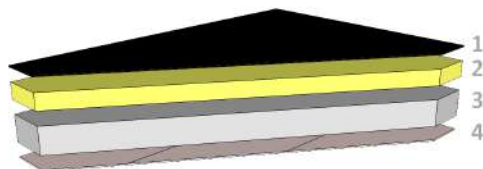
Composition de la toiture de la construction traditionnelle (Delvenne, F. 2016)
